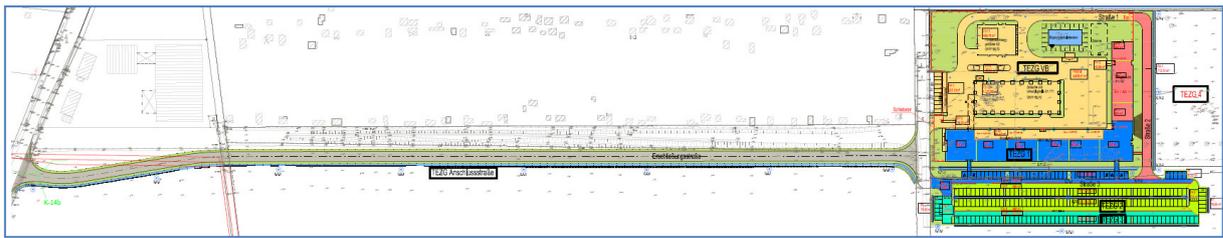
Lageplan Teileinzugsgebiet Anschlussstraße (TEZG Anschlussstraße)
